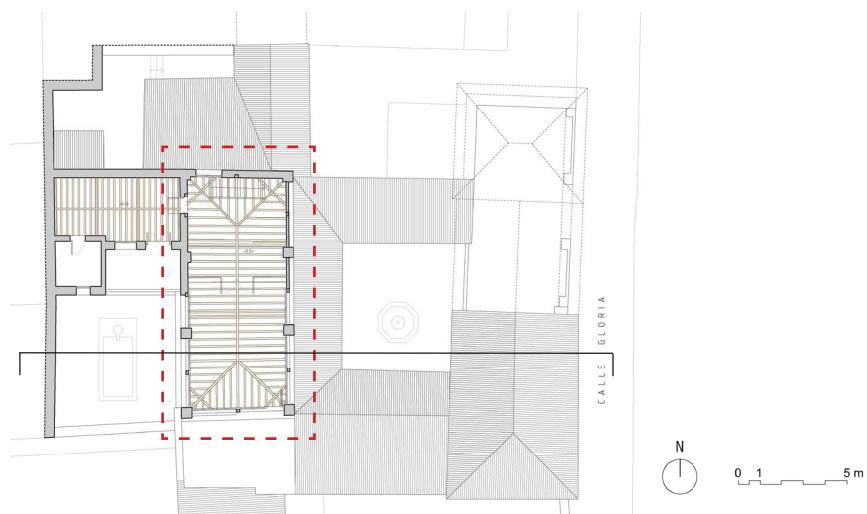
Indicación en planta del añadido de la torre-secadero con la proyección de su armadura.
